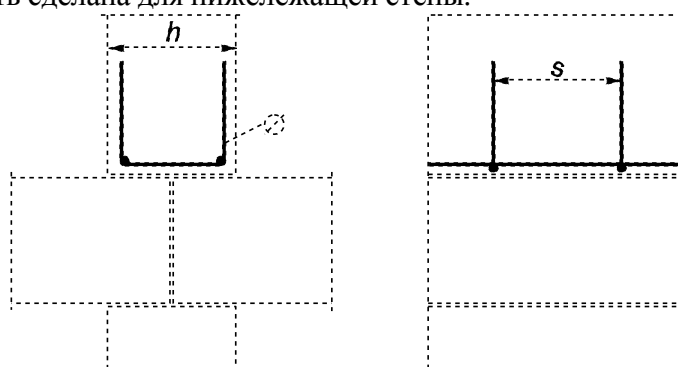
Пример армирования стены над соединением двух плит перекрытия
